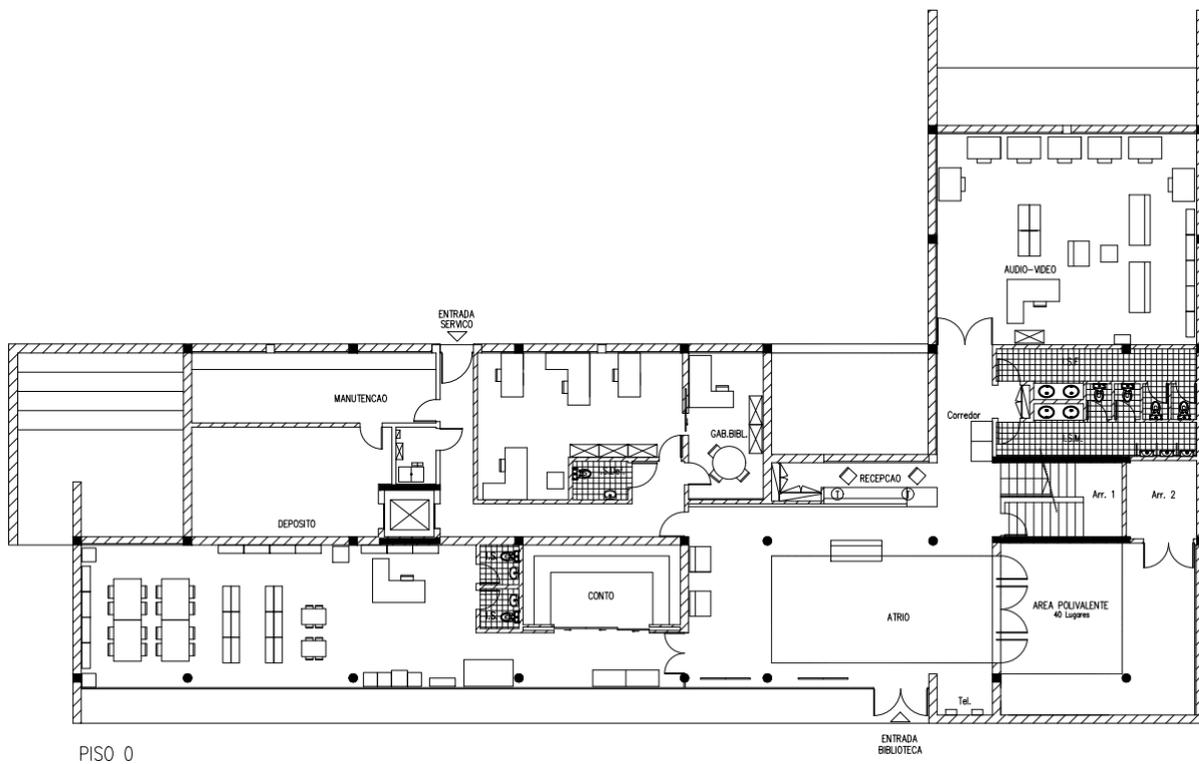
Planta equipamento piso 0 Fonte: Catarina Almeida Moita
